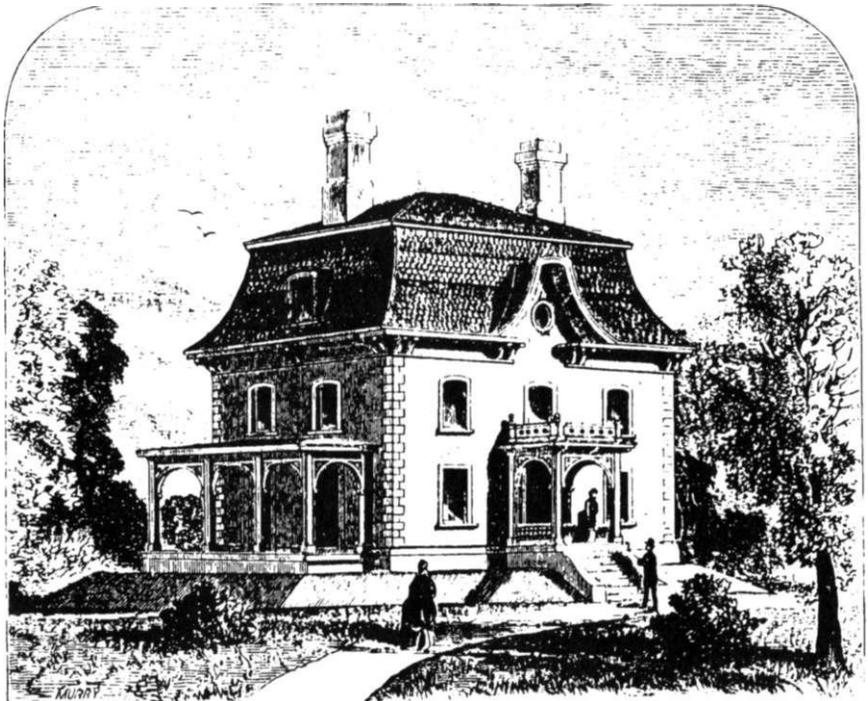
Downing: Haus mit französischem Dach (French Roof House)
